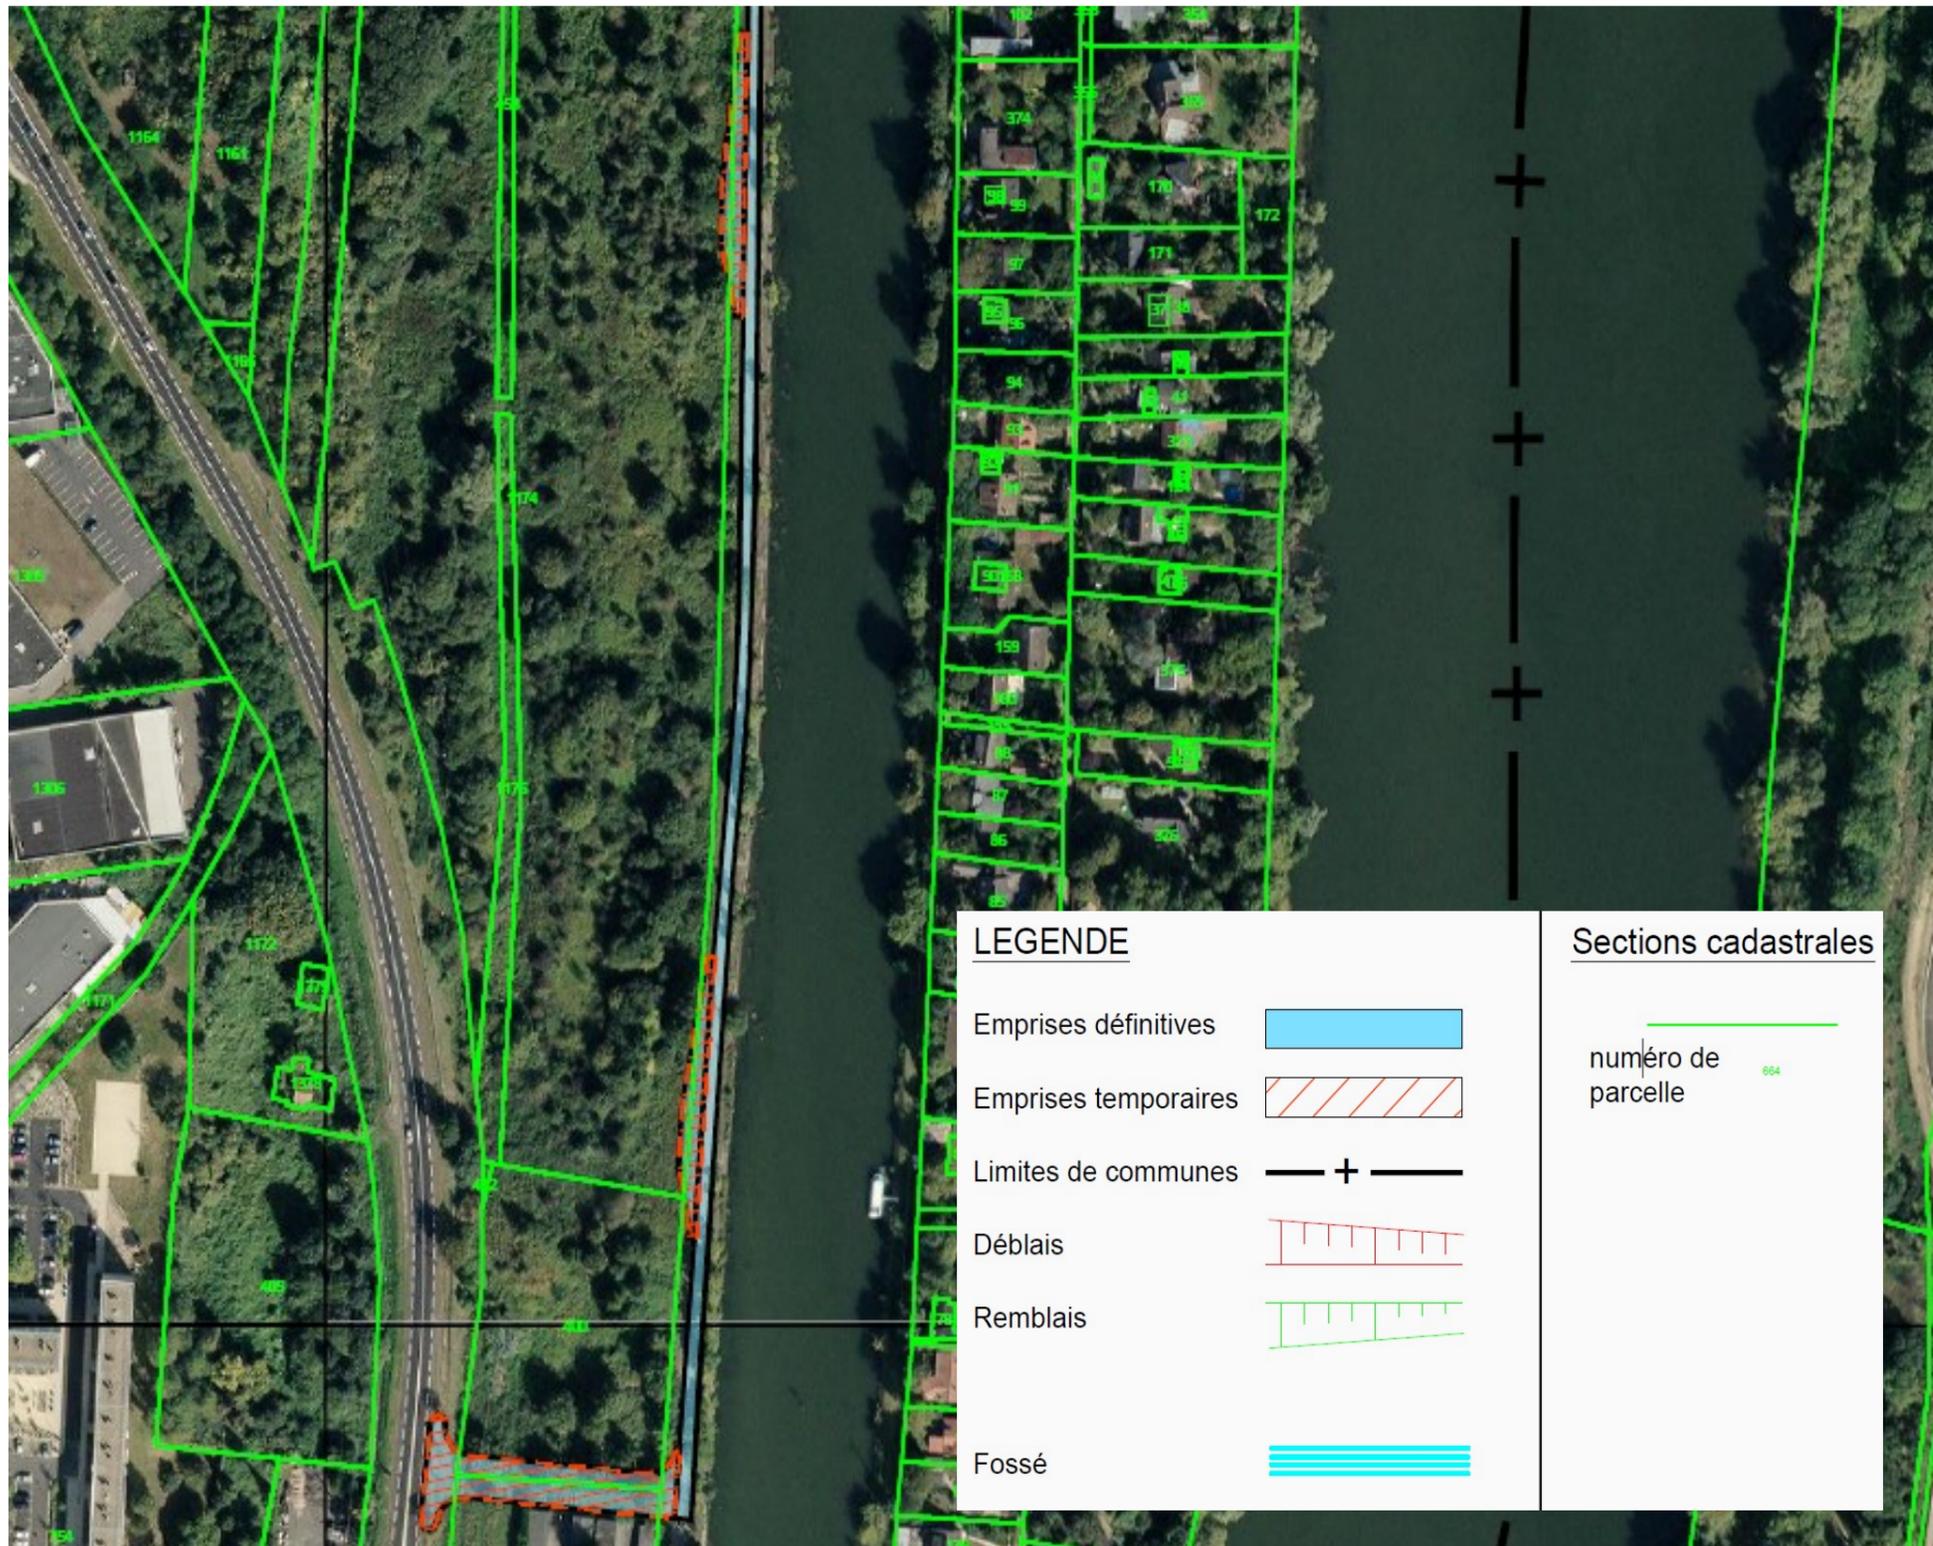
Plan des emprises travaux et des emprises définitives du projet au droit du boisement des Garennes (Sud)
